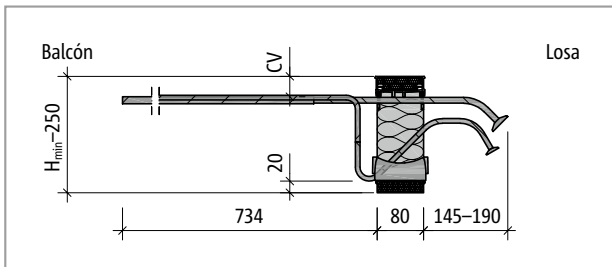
Schöck Isokorb® T tipo K-O-M2: Sección del producto
